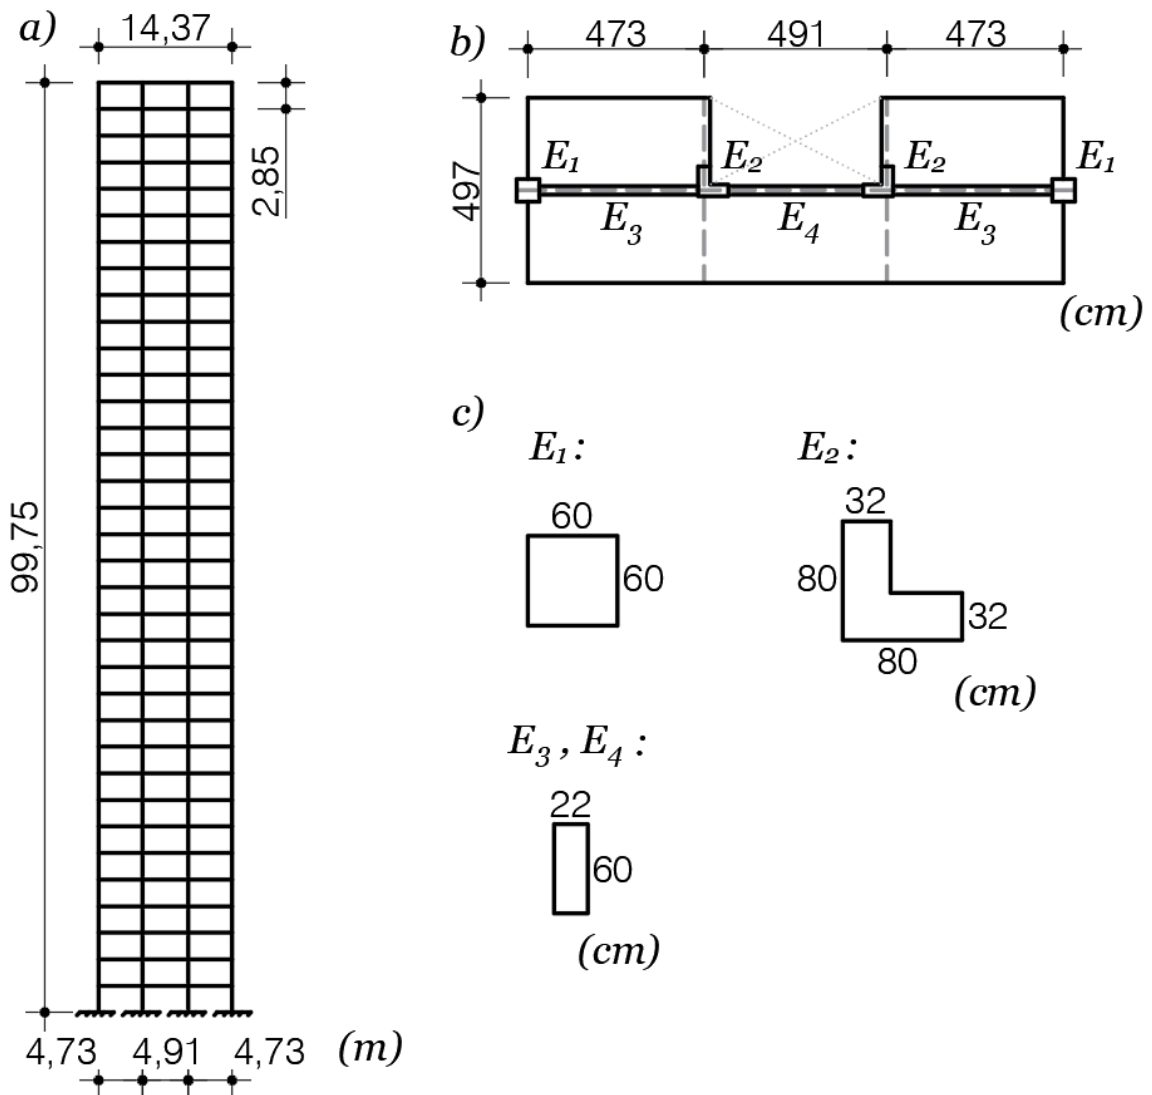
Estrutura analisada em configuração Original não controlada (C1). a) Pórtico 2D b) Seção transversal em planta considerada c) Seção transversal dos pilares ( $E_1$  e  $E_2$ ) e das vigas ( $E_3$  e  $E_4$ ).
